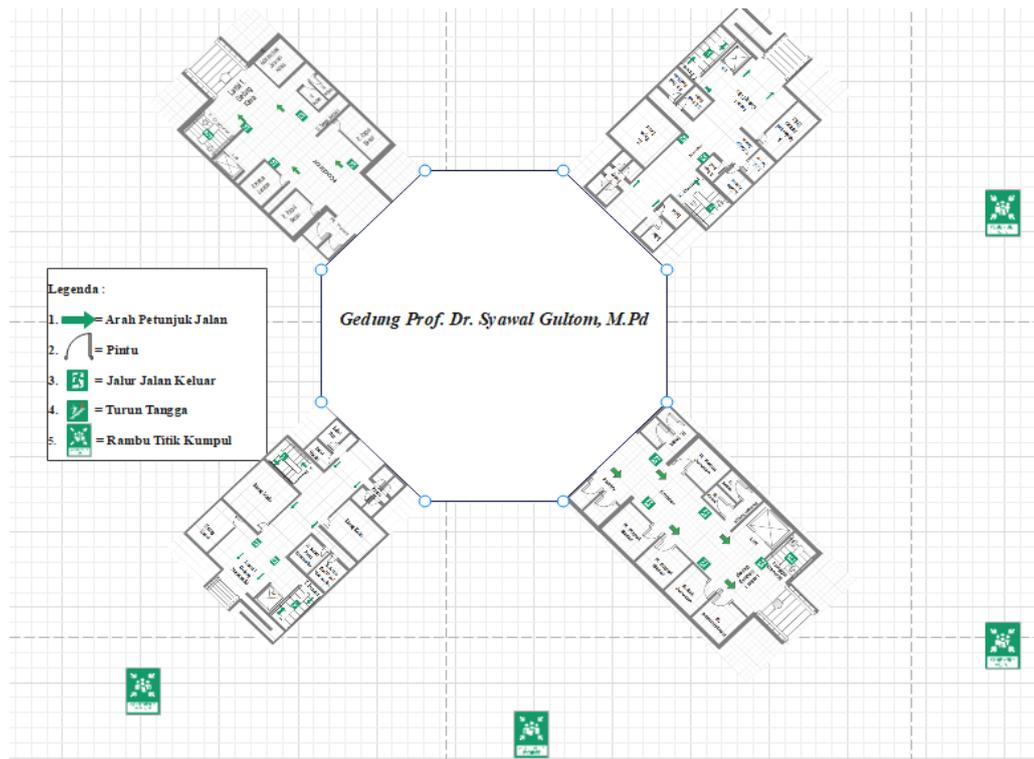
Denah Jalur Evakuasi di Gedung Kimia Berurut Sampai 10 Lantai
